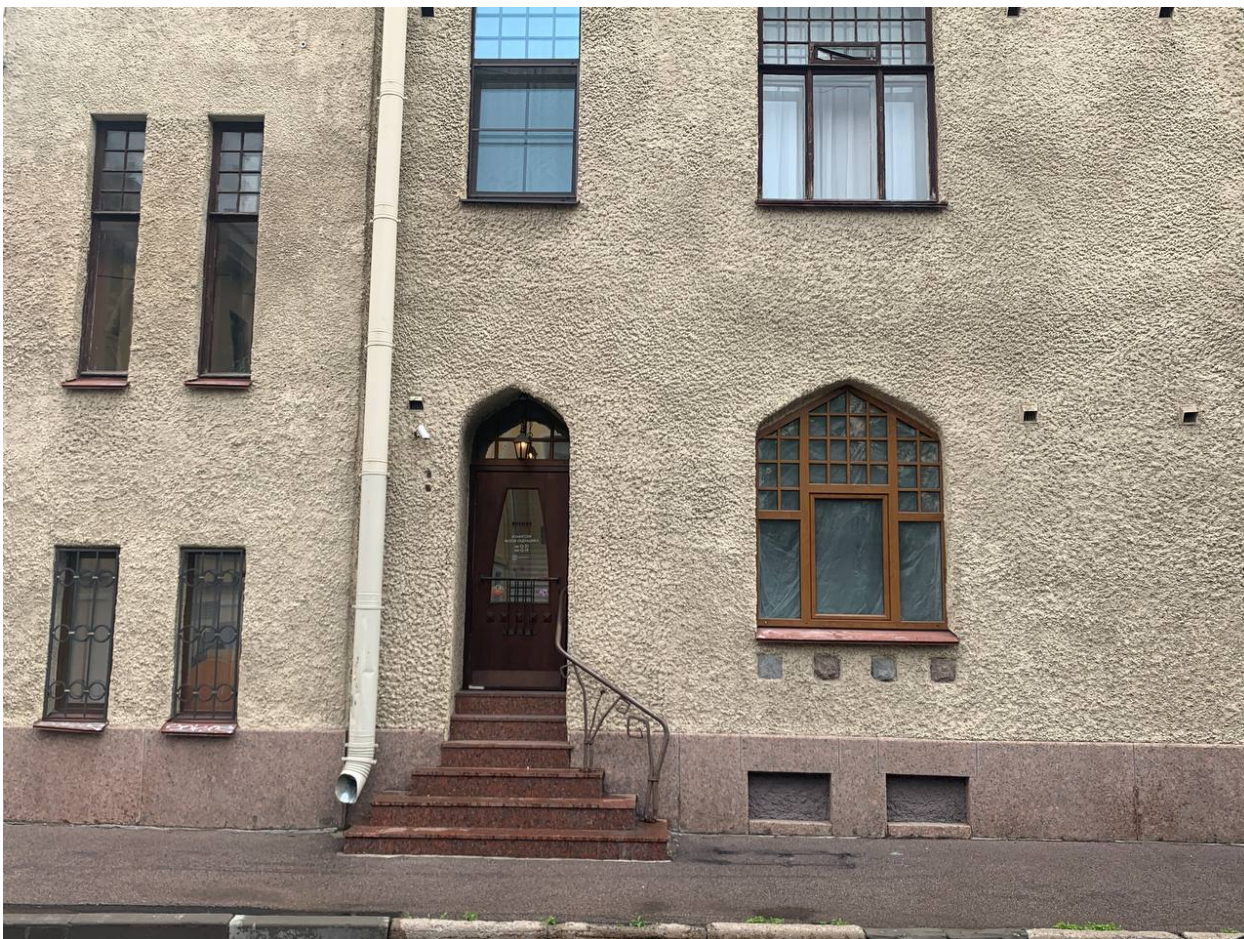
Общий вид на фрагмент лицевого фасада здания со стороны Стрельнинской ул.
